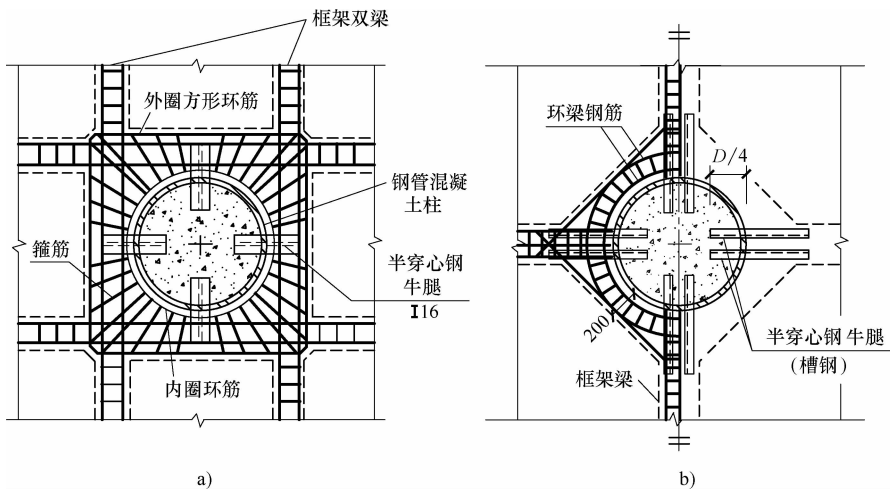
钢管混凝土柱与钢筋混凝土梁的连接
